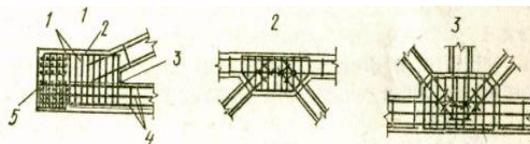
Конструкция железобетонных стропильных ферм:
